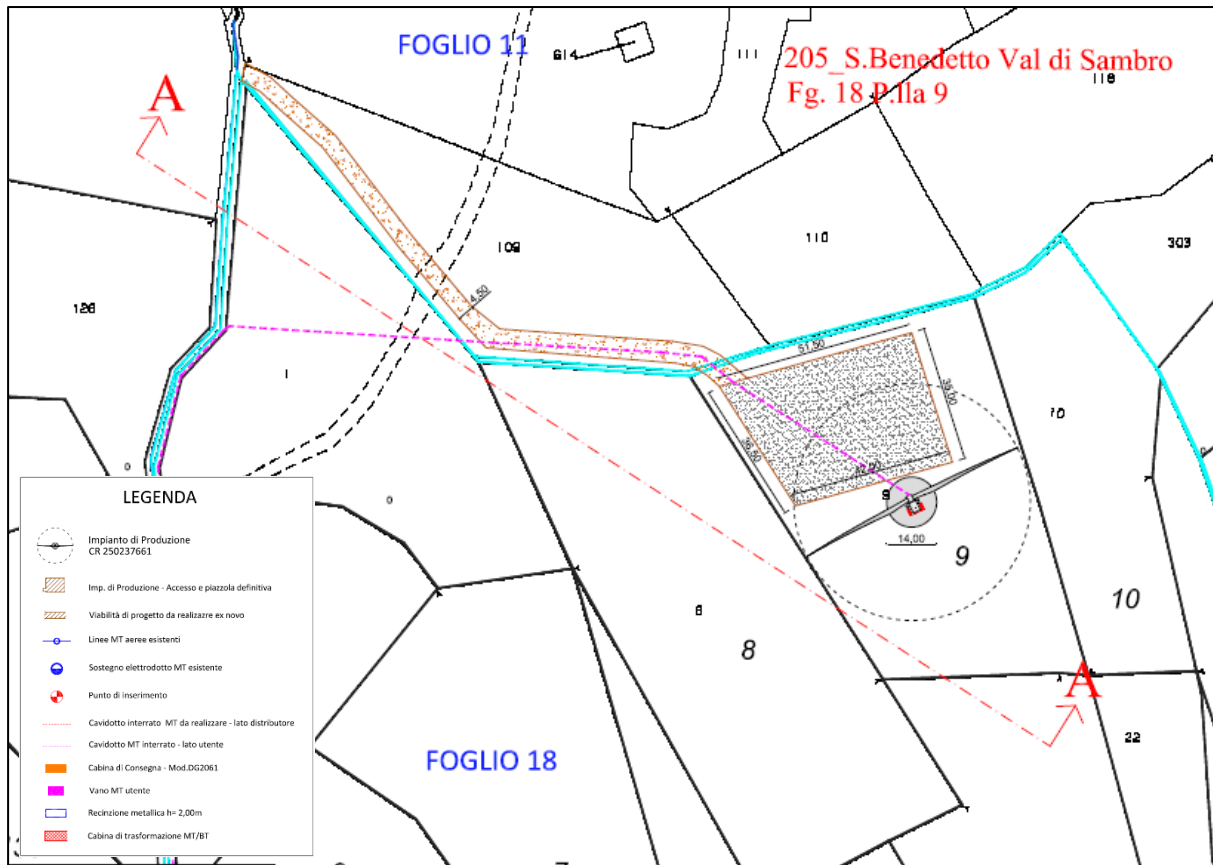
Inquadramento dell'impianto eolico su planimetria catastale
